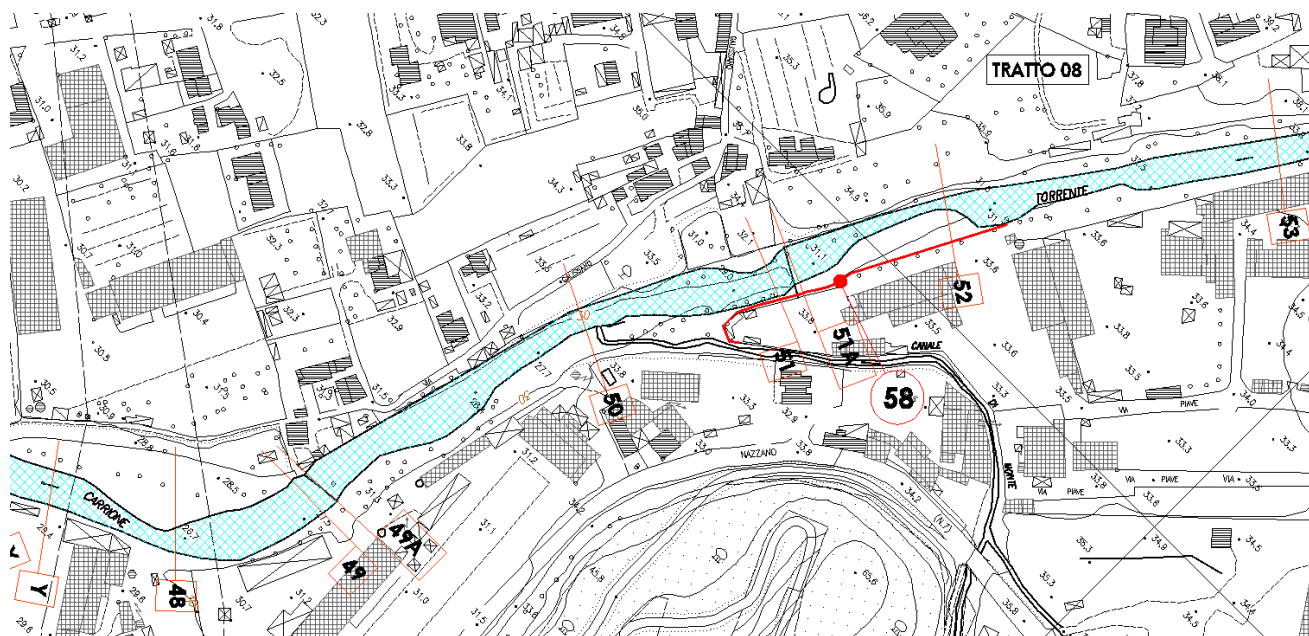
Inquadrimento planimetrico – Tratto 08 – Sponda sinistra
